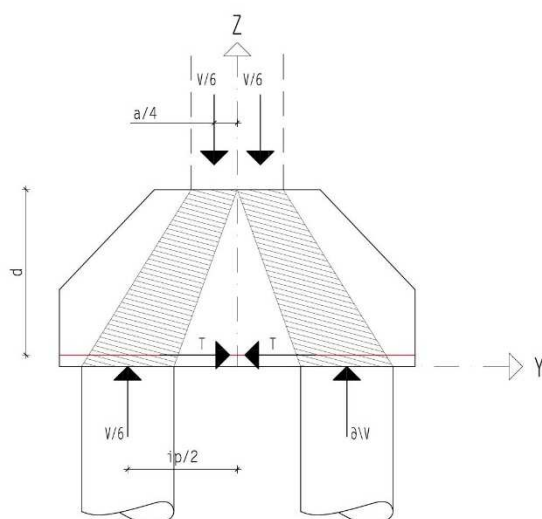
Schema di calcolo puntone-tirante per il plinto di fondazione
